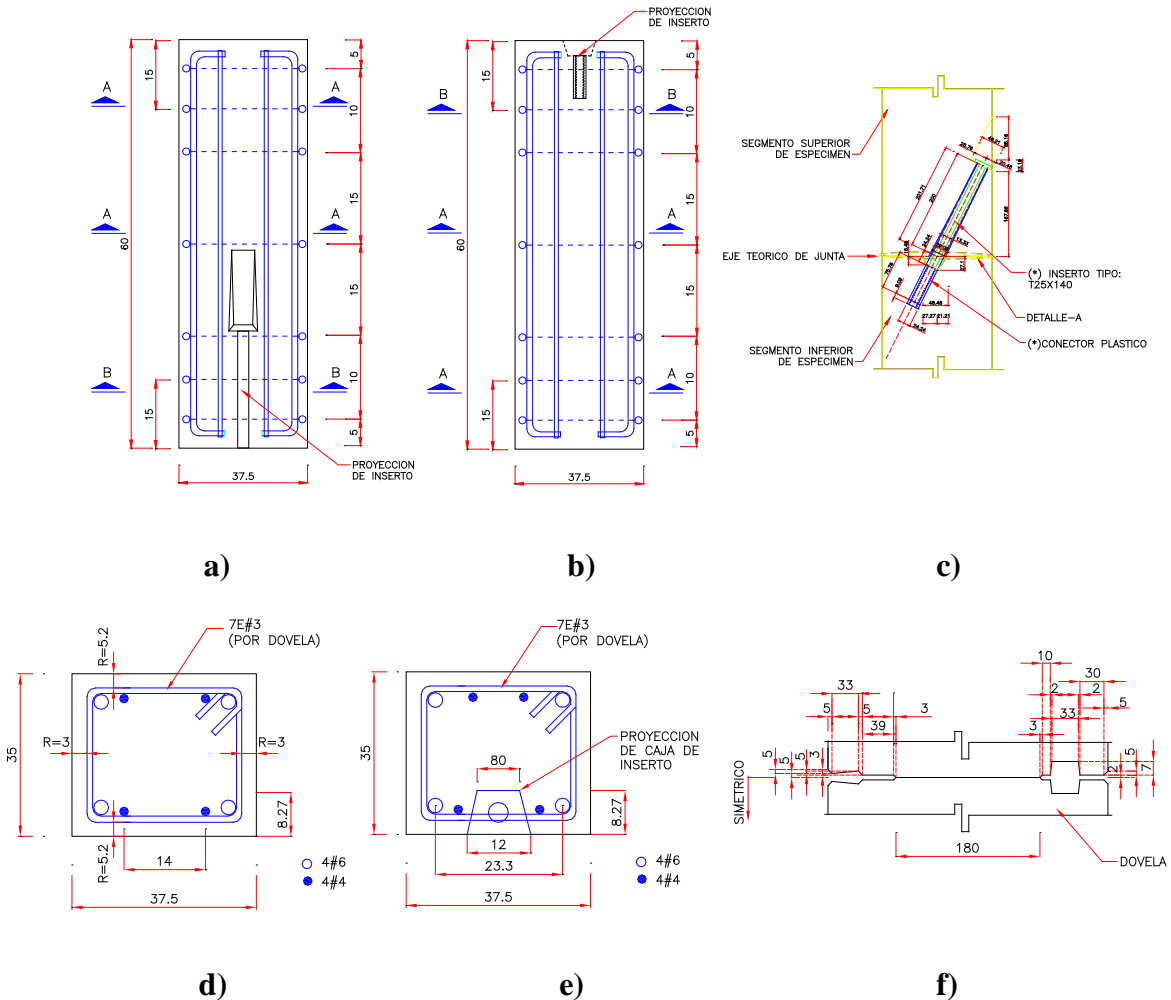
Plano estructural de los especímenes obtenido de ICA (2009): a) dovela superior (vista en elevación); b) dovela inferior (vista en elevación); c) junta entre dovelas, detalle típico de inserto; d) corte A-A; e) corte B-B; f) geometría de la junta entre dovelas
